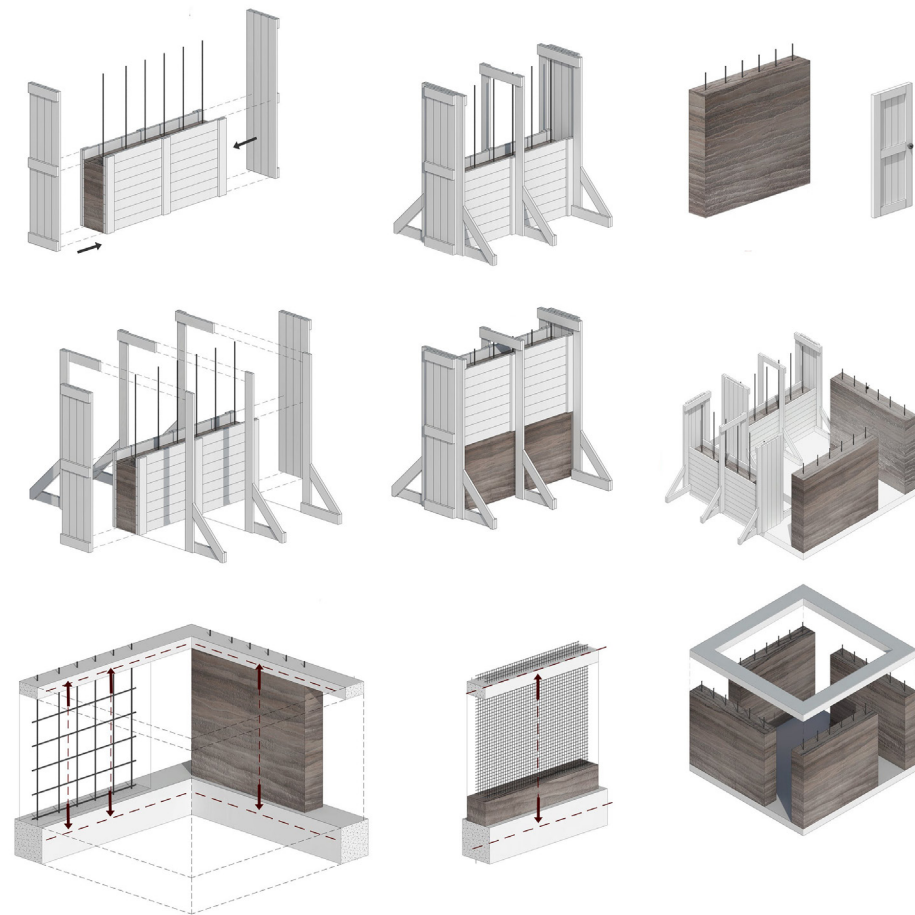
Diagramas de construcción en tierra. Fuente: Plataforma arquitectura.
